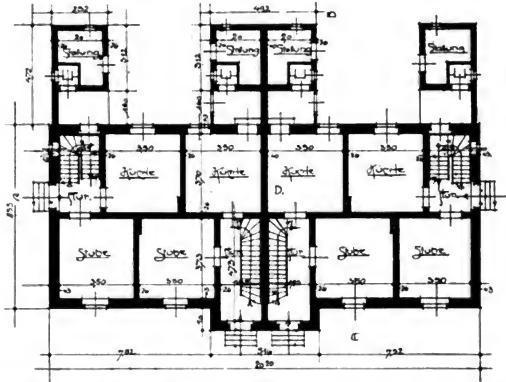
Grundriß zu Abb. 94. Dachgeschoß.
